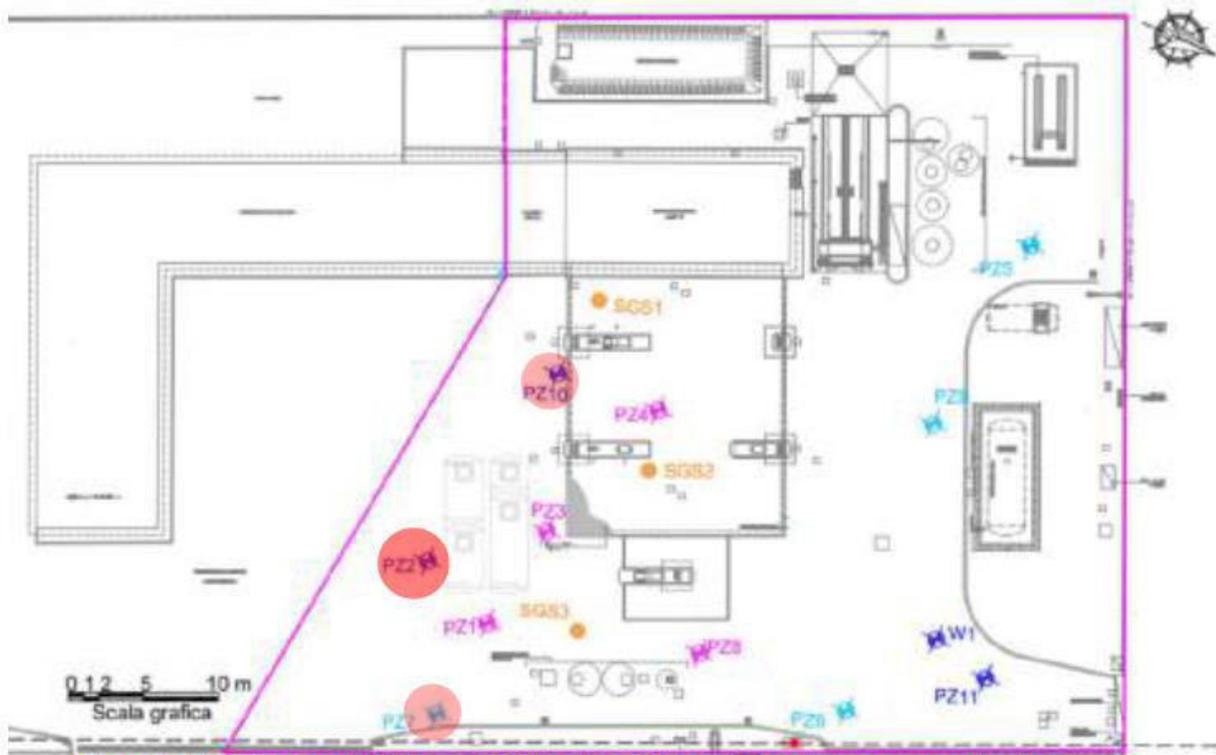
Planimetria del sito con identificazione dei pozzi oggetto delle prove idrauliche
